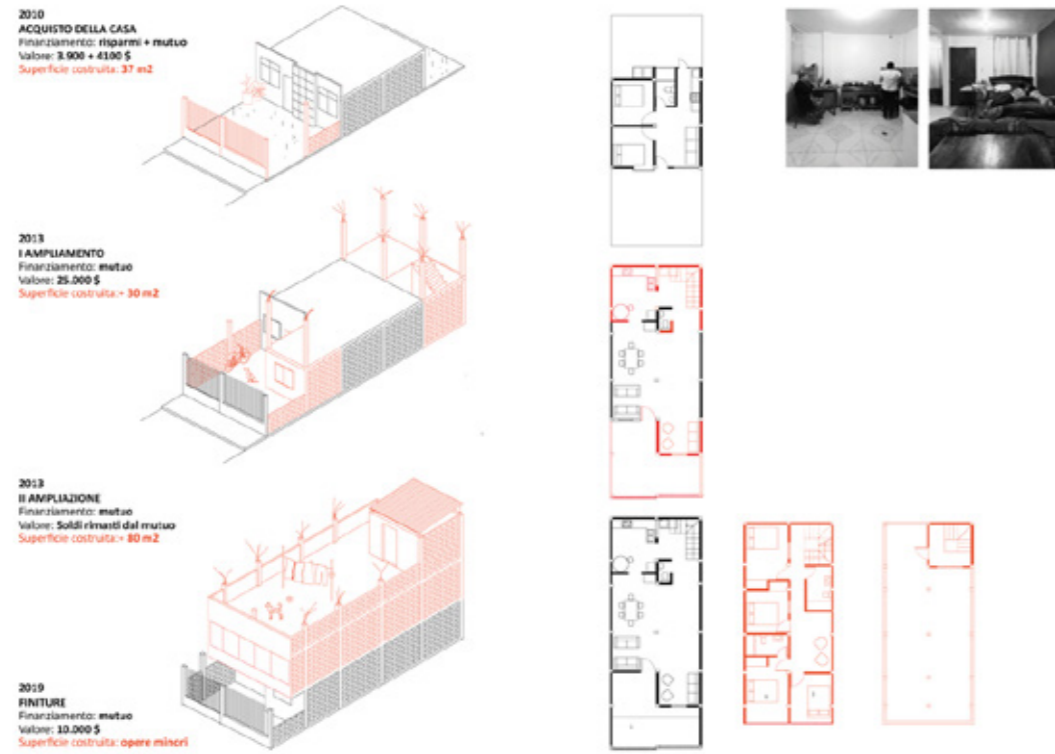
Ficha de la vivienda de la familia Macay. Elaborado por el autor.
